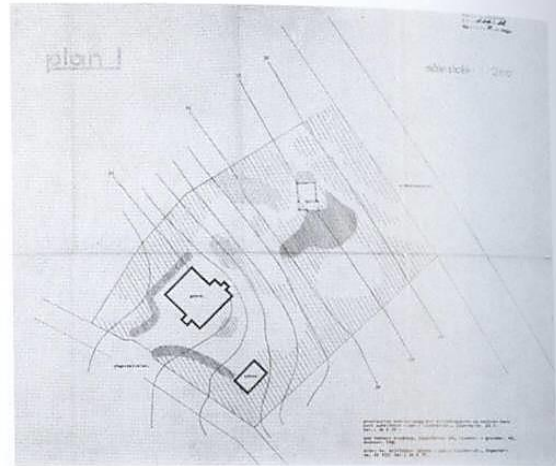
Ernst Schwitters, Plan I (Lageplan), 1938
